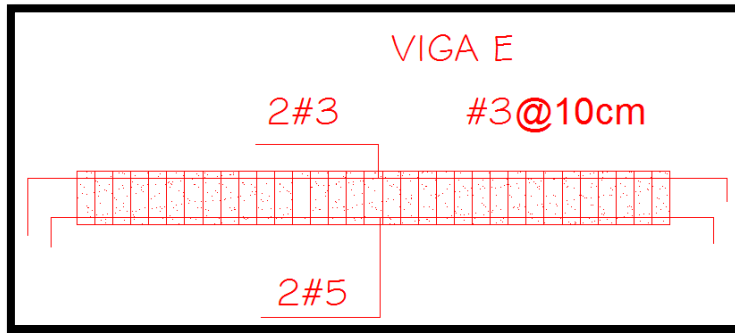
Perfil de viga E de la escalera con su distribución de acero de refuerzo.
